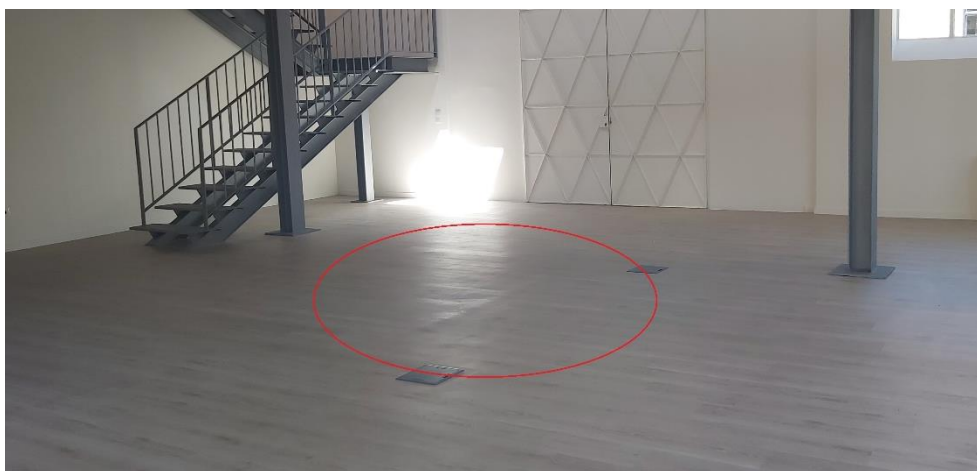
Fotografia da lomba causada pelo levantamento do pavimento devido às juntas de retração.
